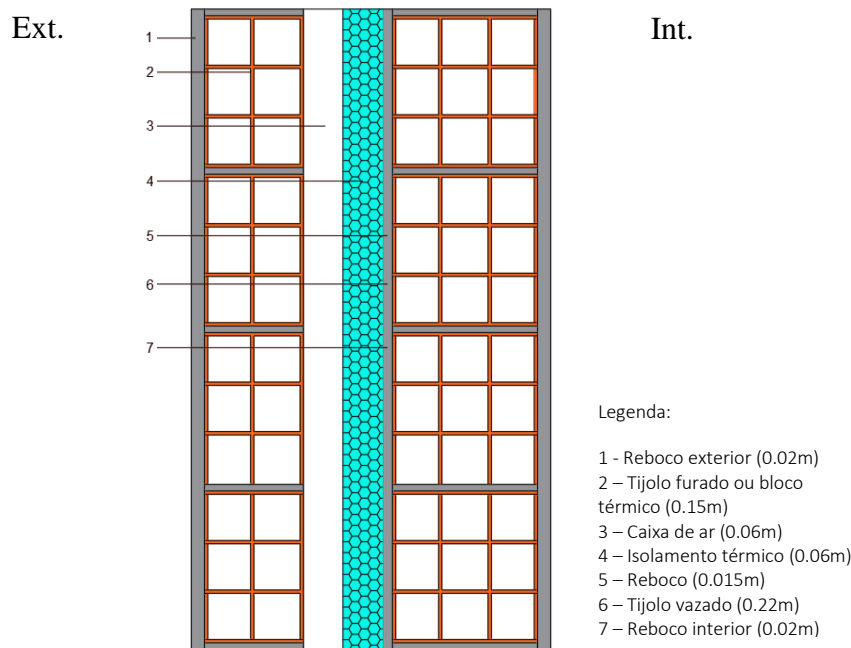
Pormenor construtivo referente à solução construtiva parede dupla
